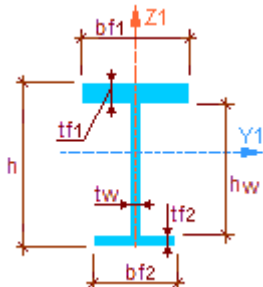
Схема профиля Двутавр сварной несимметричный
